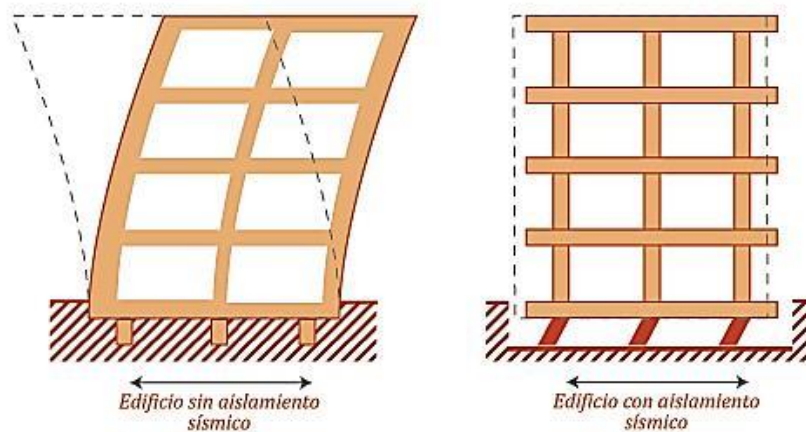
a) Estructura sin aislamiento. b) Estructura aislada
